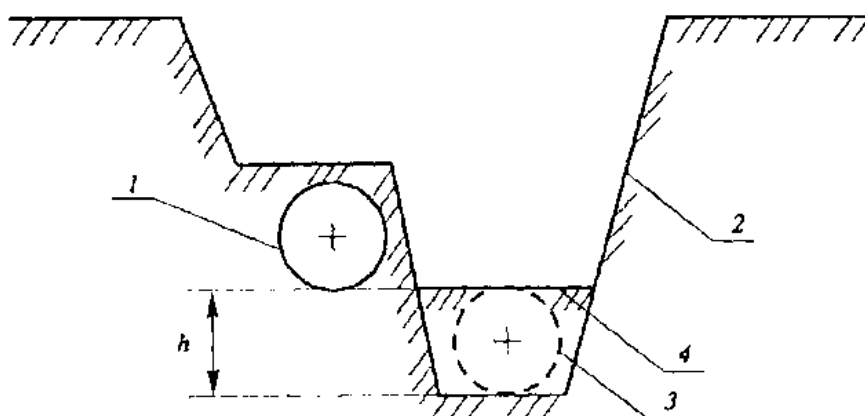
Профиль траншеи при ремонте с заменой труб путем укладки в совмещенную траншею ниже существующего нефтепровода: 1 – заменяемый участок нефтепровода; 2 – траншея; 3 – вновь прокладываемый участок нефтепровода; 4 – перемычка; h – величина заглубления.
